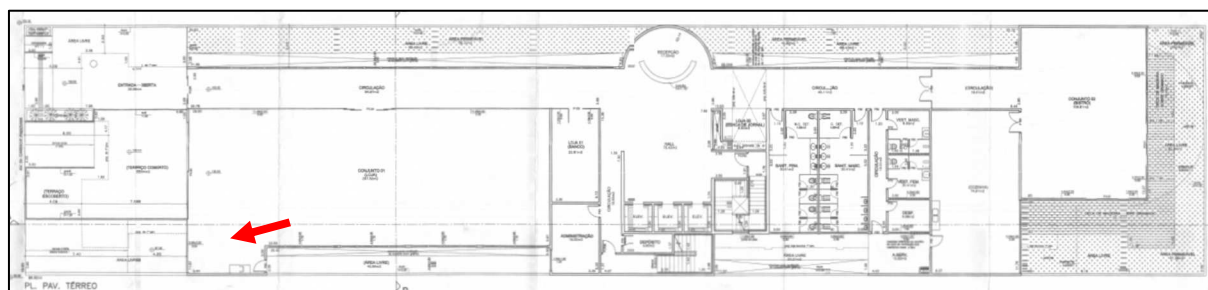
Sala 1 do pavimento térreo.
